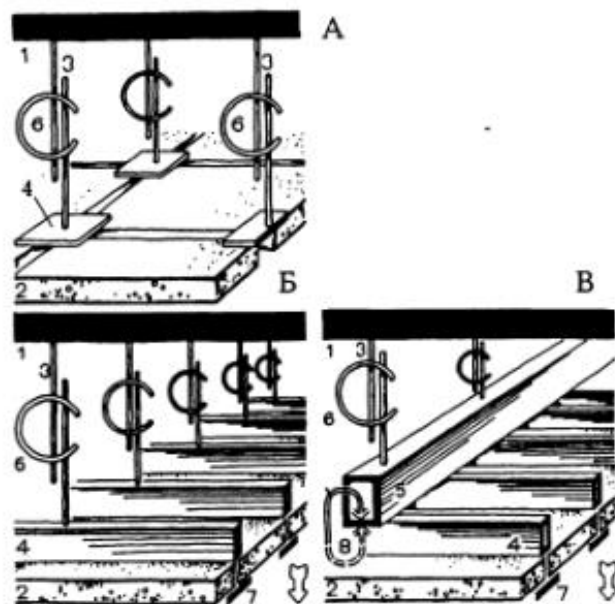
Схемы потолочных подвесных систем: А, Б, В - подвески потолочных элементов: автономная (А); с продольным несущим каркасом (Б) и с перекрёстным каркасом (В); 1 - несущая конструкция перекрытия; 2 - отделочный элемент потолка; 3 - детали подвески; 4 - несущие элементы; 5 - распределительный элемент; 6 - устройства регулировки длины подвесок; 7 - установочные элементы потолочных плит; 8 - соединения несущих элементов с распределительными
